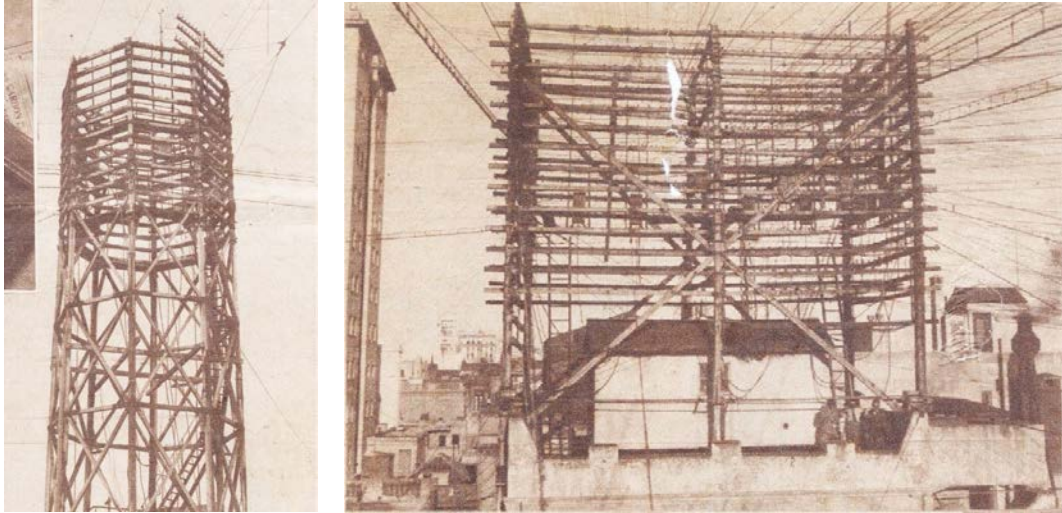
Torres utilizadas para soporte de cables de telefonía por el año 1933
